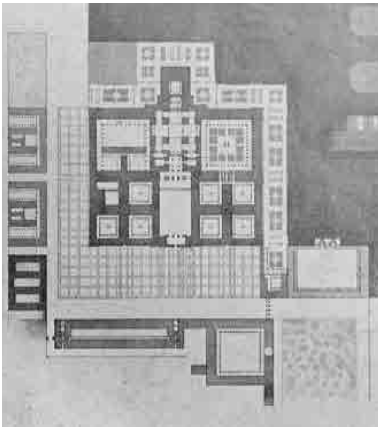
Plano general de planta de El Escorial. En este caso, la trama de patios queda recogida dentro de un perímetro previamente definido.
